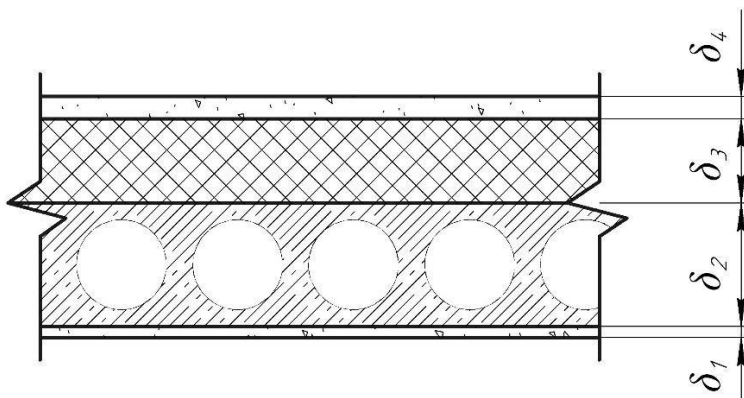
Схема конструкції горищного перекриття до теплотехнічного розрахунку
